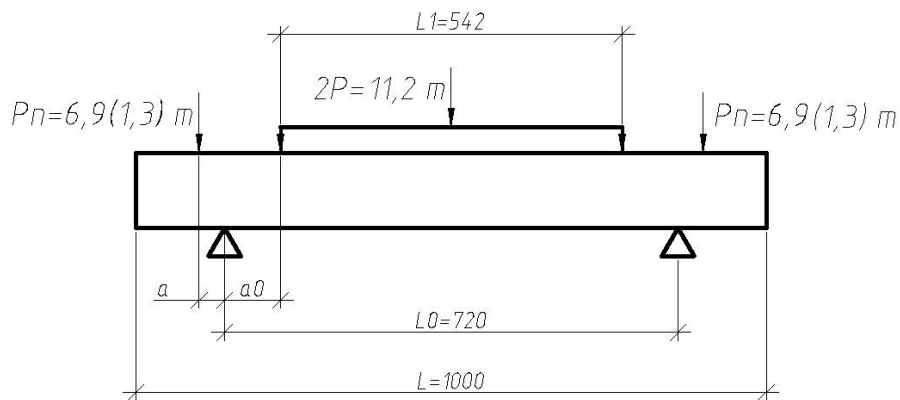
Розрахункова схема залізобетонної балки
